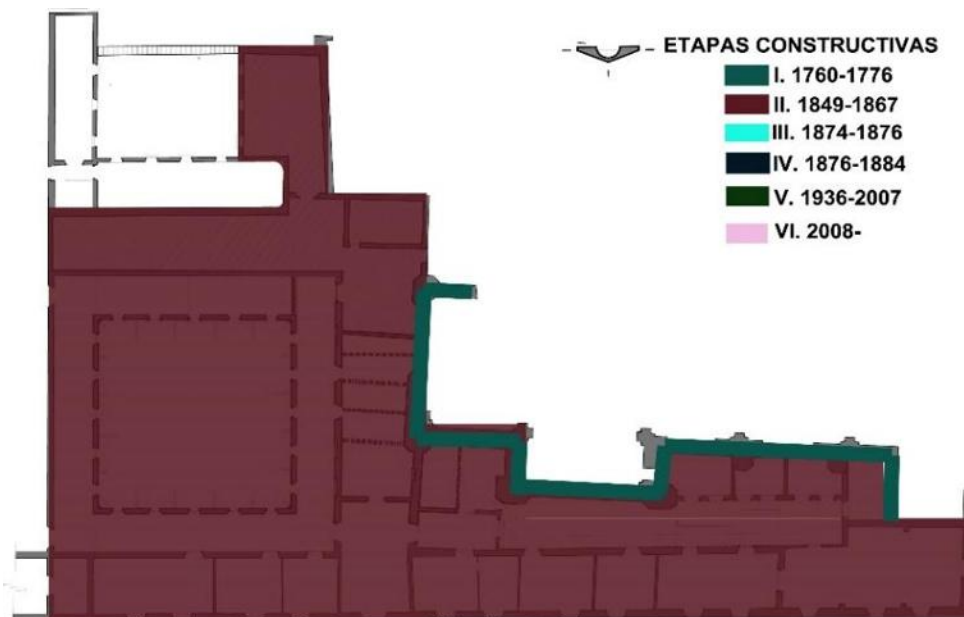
Segunda etapa de construcción (Planta alta)¹²⁸
